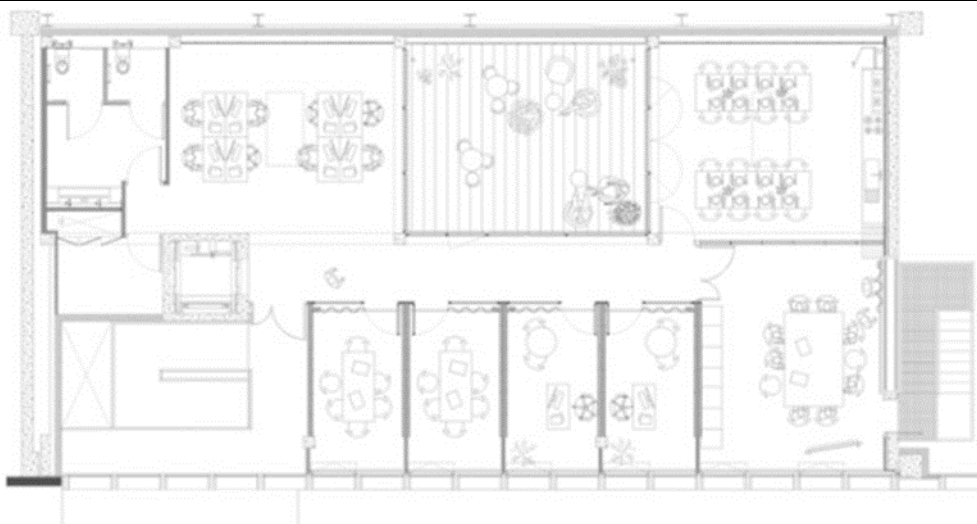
План второго этажа фабрики в Тараре, Франция
